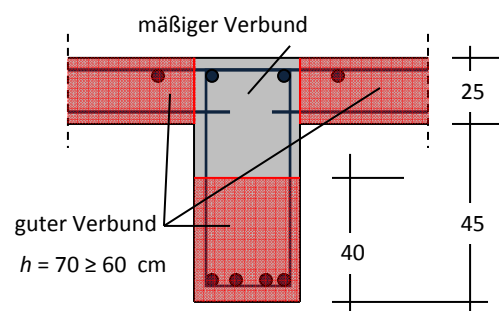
mäßiger Verbundbereich durch Betonablösung auf der Unterseite des Stabes aufgrund des Verdichtungsprozesses nach dem Betonieren
